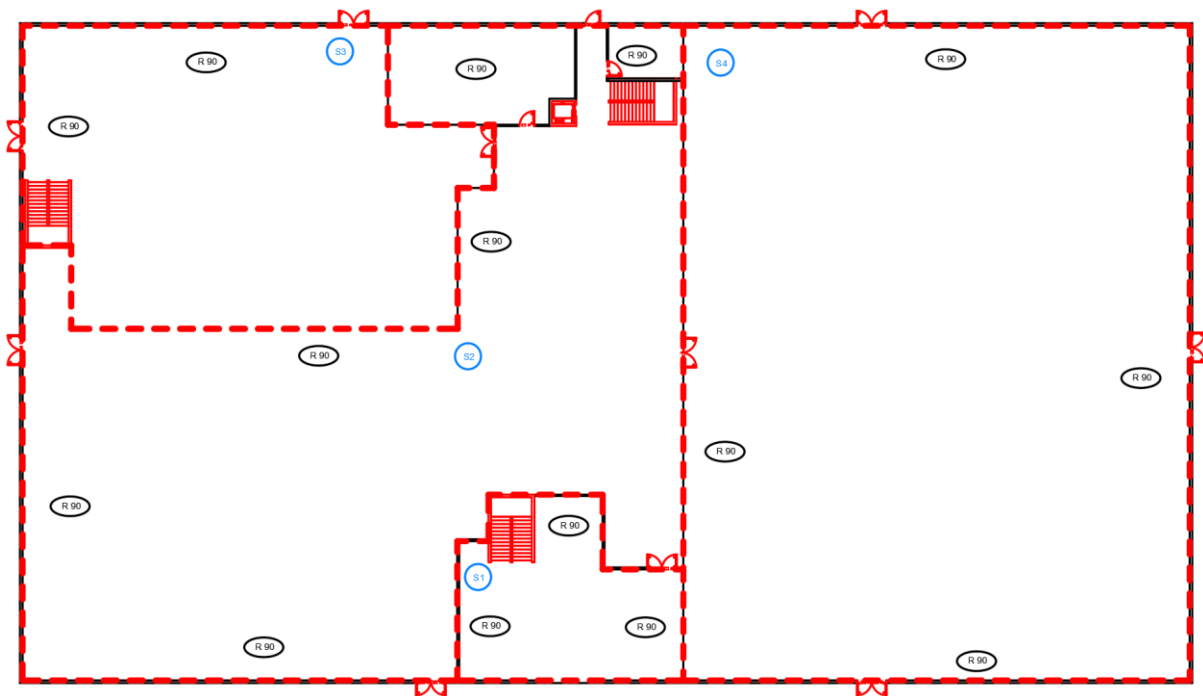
Resistencia al fuego de la estructura portante proyectada para la planta baja.
